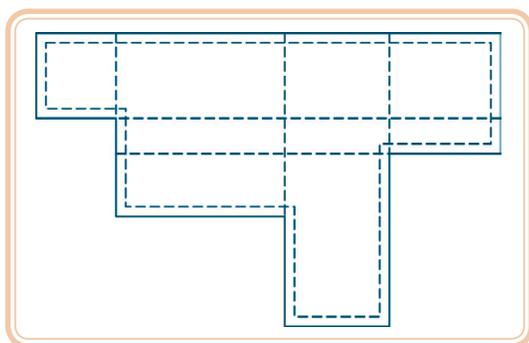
Etapas do traçado de um telhado – retângulos inscritíveis
